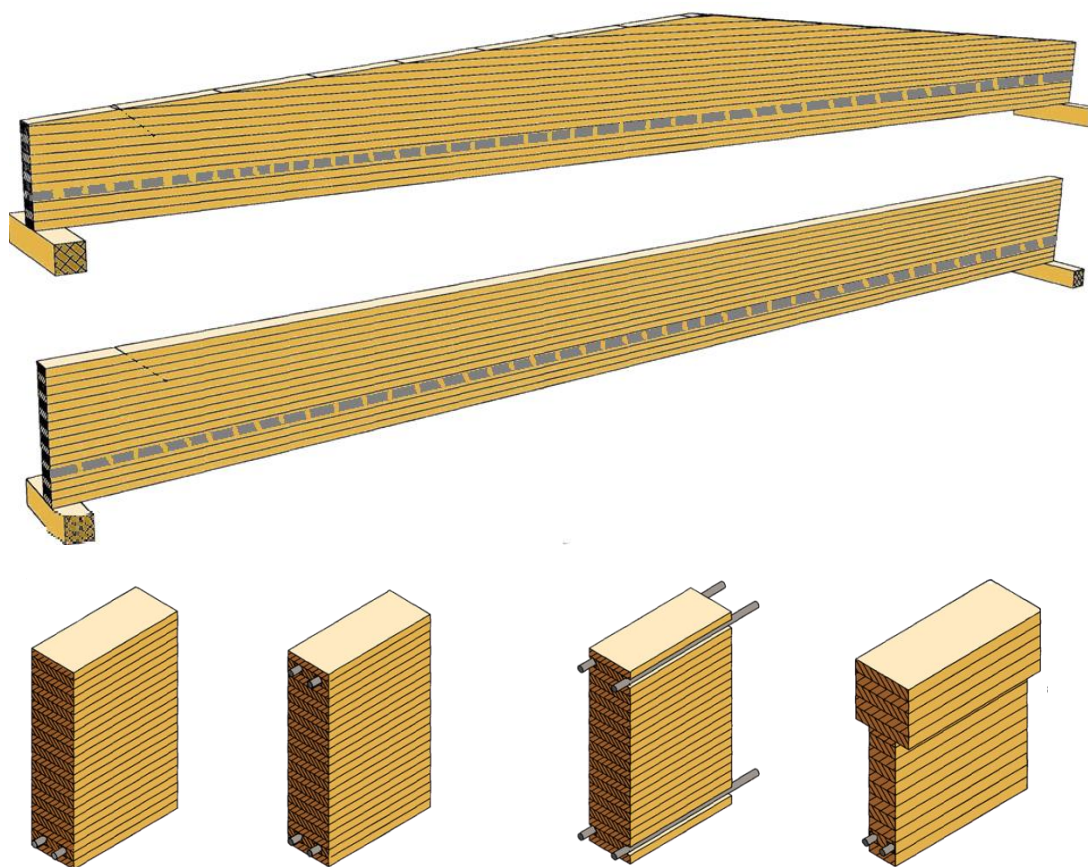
Балки, армированные стальными стержнями: а - одиночное армирование; б - двойное армирование
